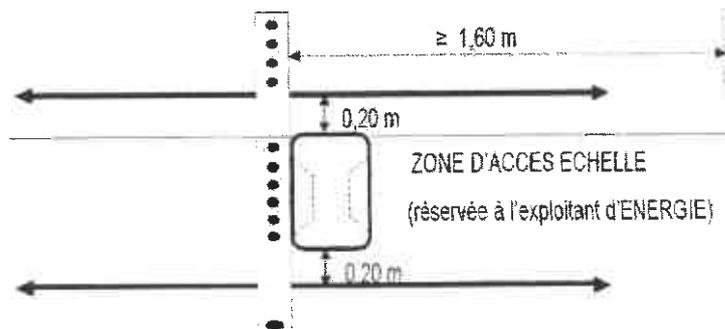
Zone d'accès échelle sur Réseau BT et mixte
